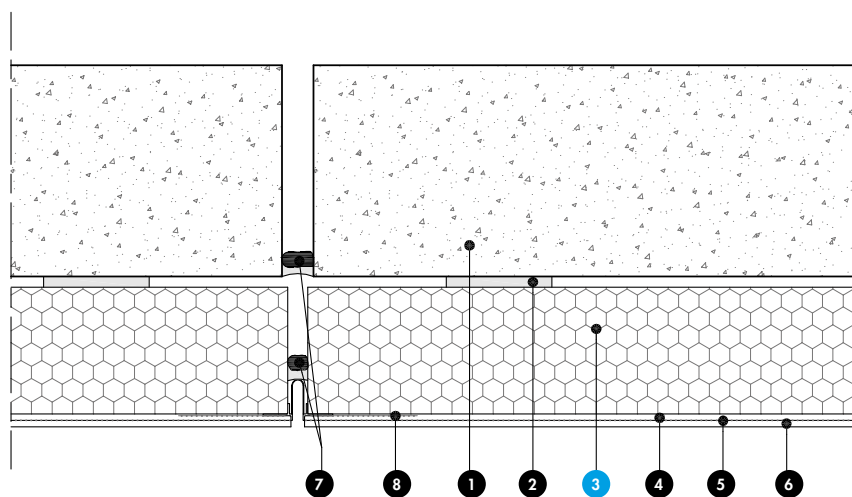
Joint de dilatation : surface plane (coupe horizontale)
